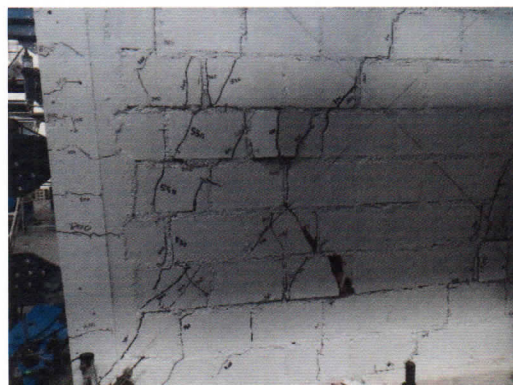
Levantamiento de un ladrillo en la parte central Este de la cara Norte para una distorsión de 1/200.
